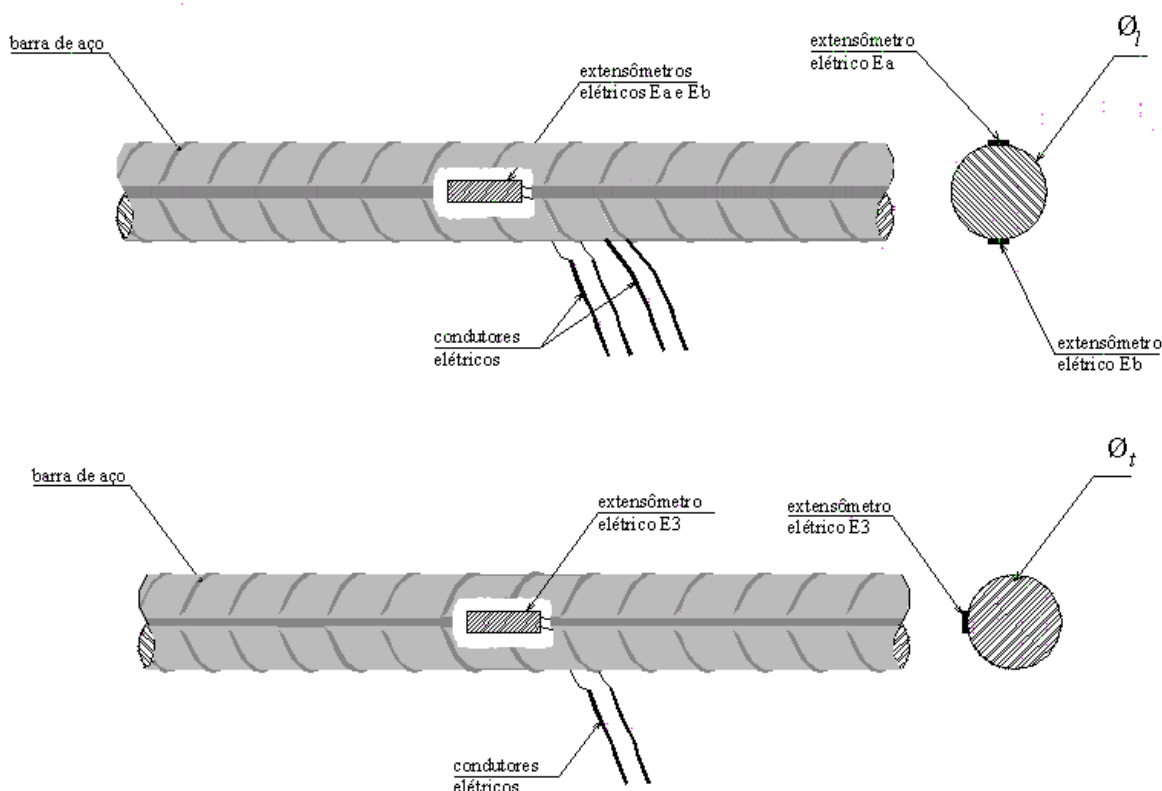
Detalhe da instalação de extensômetros nas armaduras das lajes
